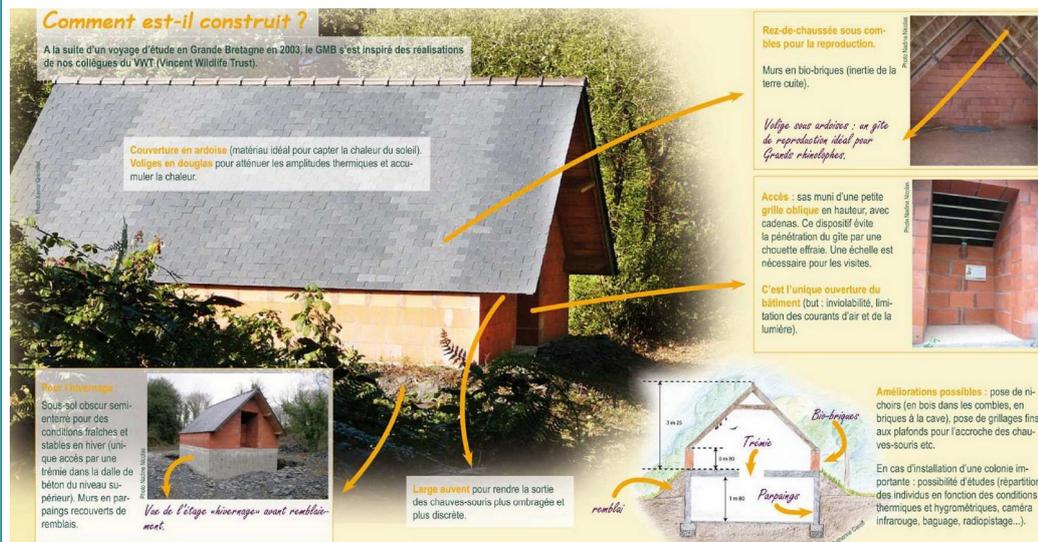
Exemple de construction réalisée (Source : Groupe mammalogique breton)
